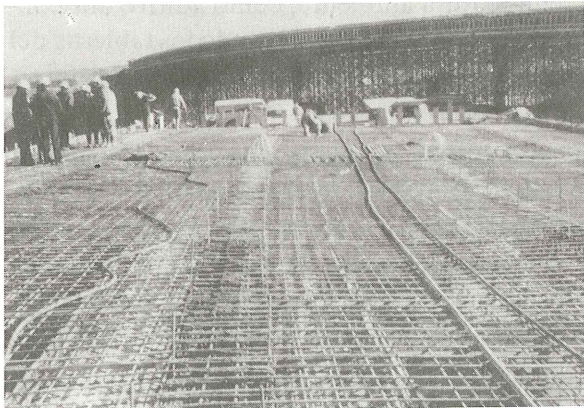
Ferralla del puente 1 y vista de la cimbra del puente 3.
